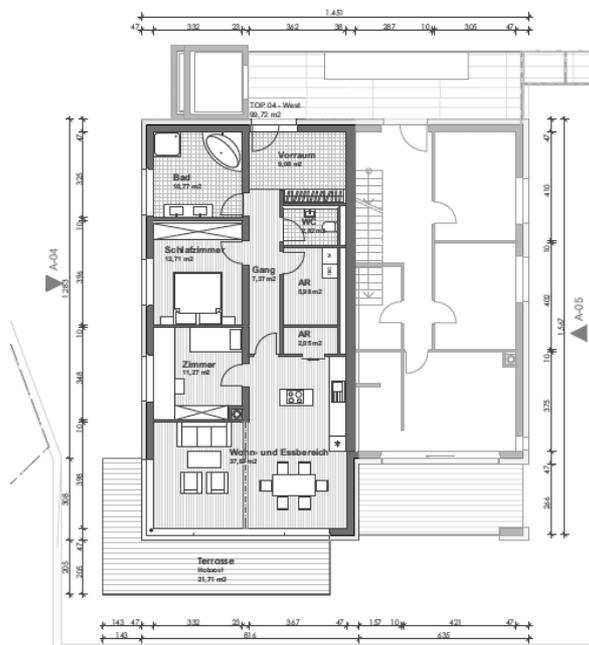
Verkaufsplan Grundriss (Beispiel)¹⁰¹
